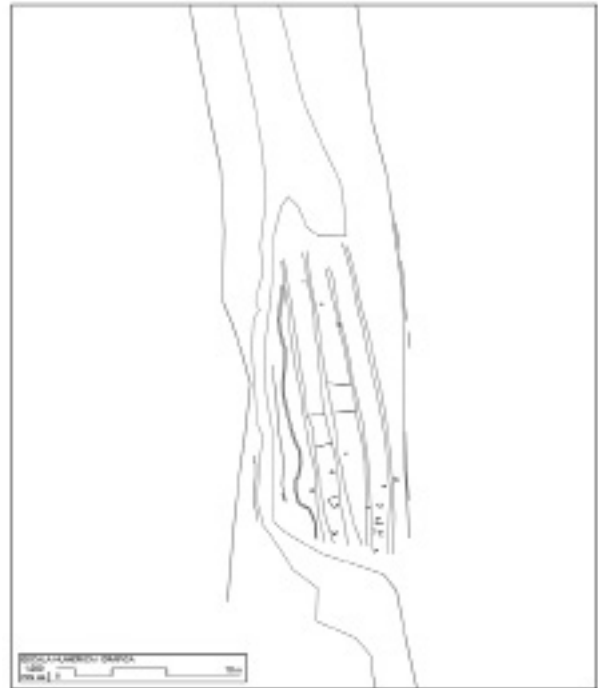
Planta general de les restes descobertes en el tram de camí excavat.
